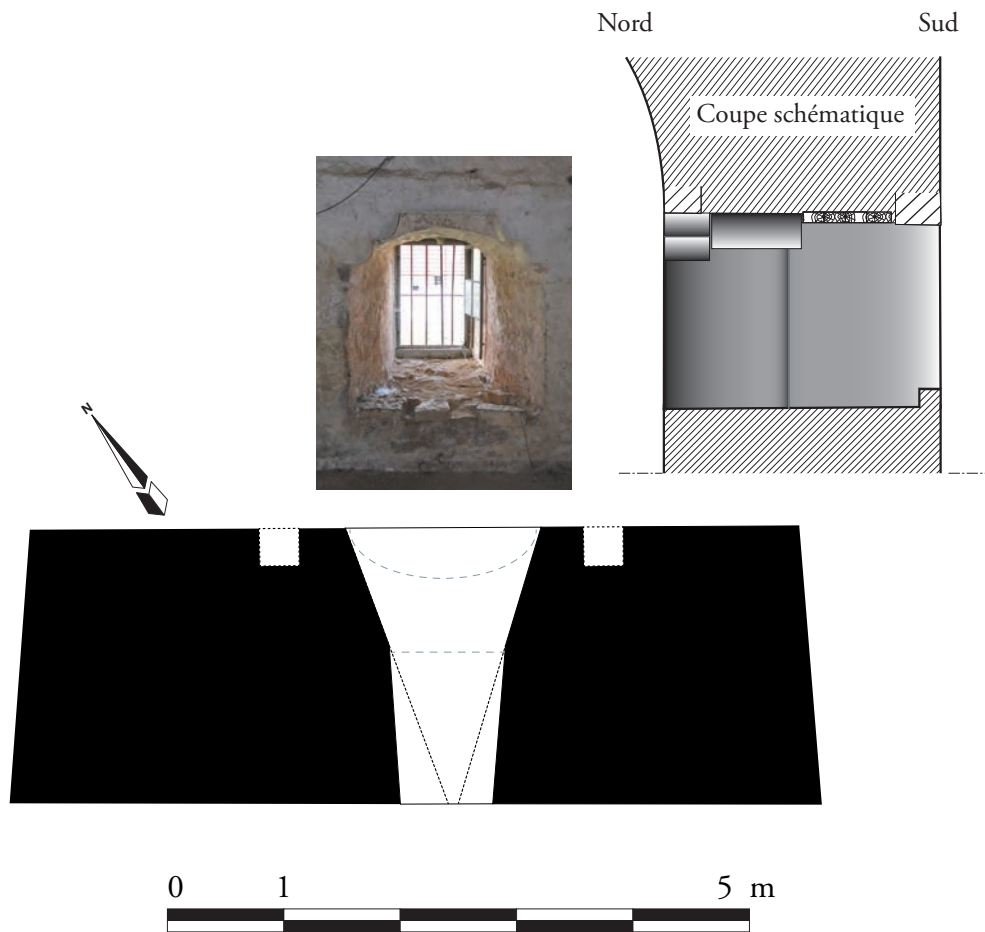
Plan, coupe schématique et élévation intérieure de la fenêtre (UM1-1-UC1)
